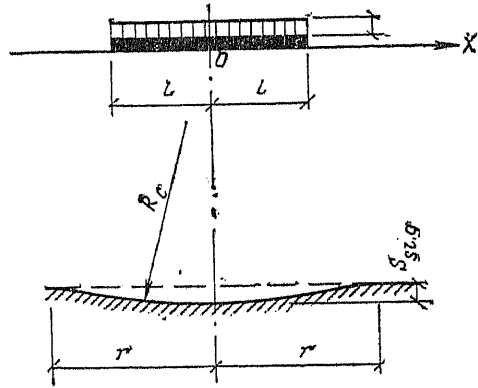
Схема и расчетные параметры фундаментов и зданий на просадку от собственного веса грунта
